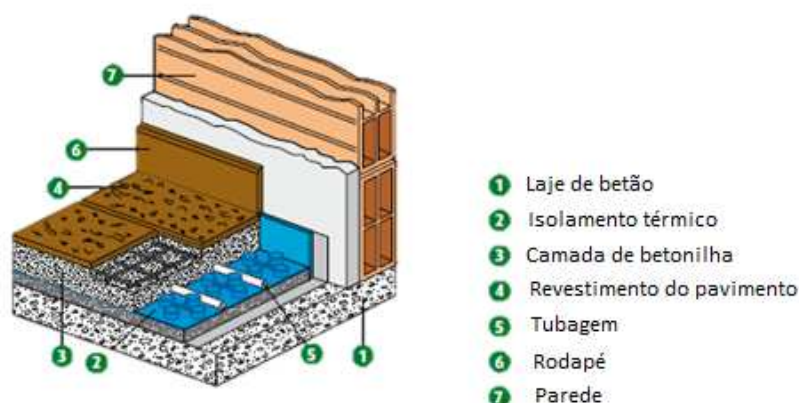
Representação da estrutura do sistema de pavimento radiante (adaptado de (Solius, 2013)).
